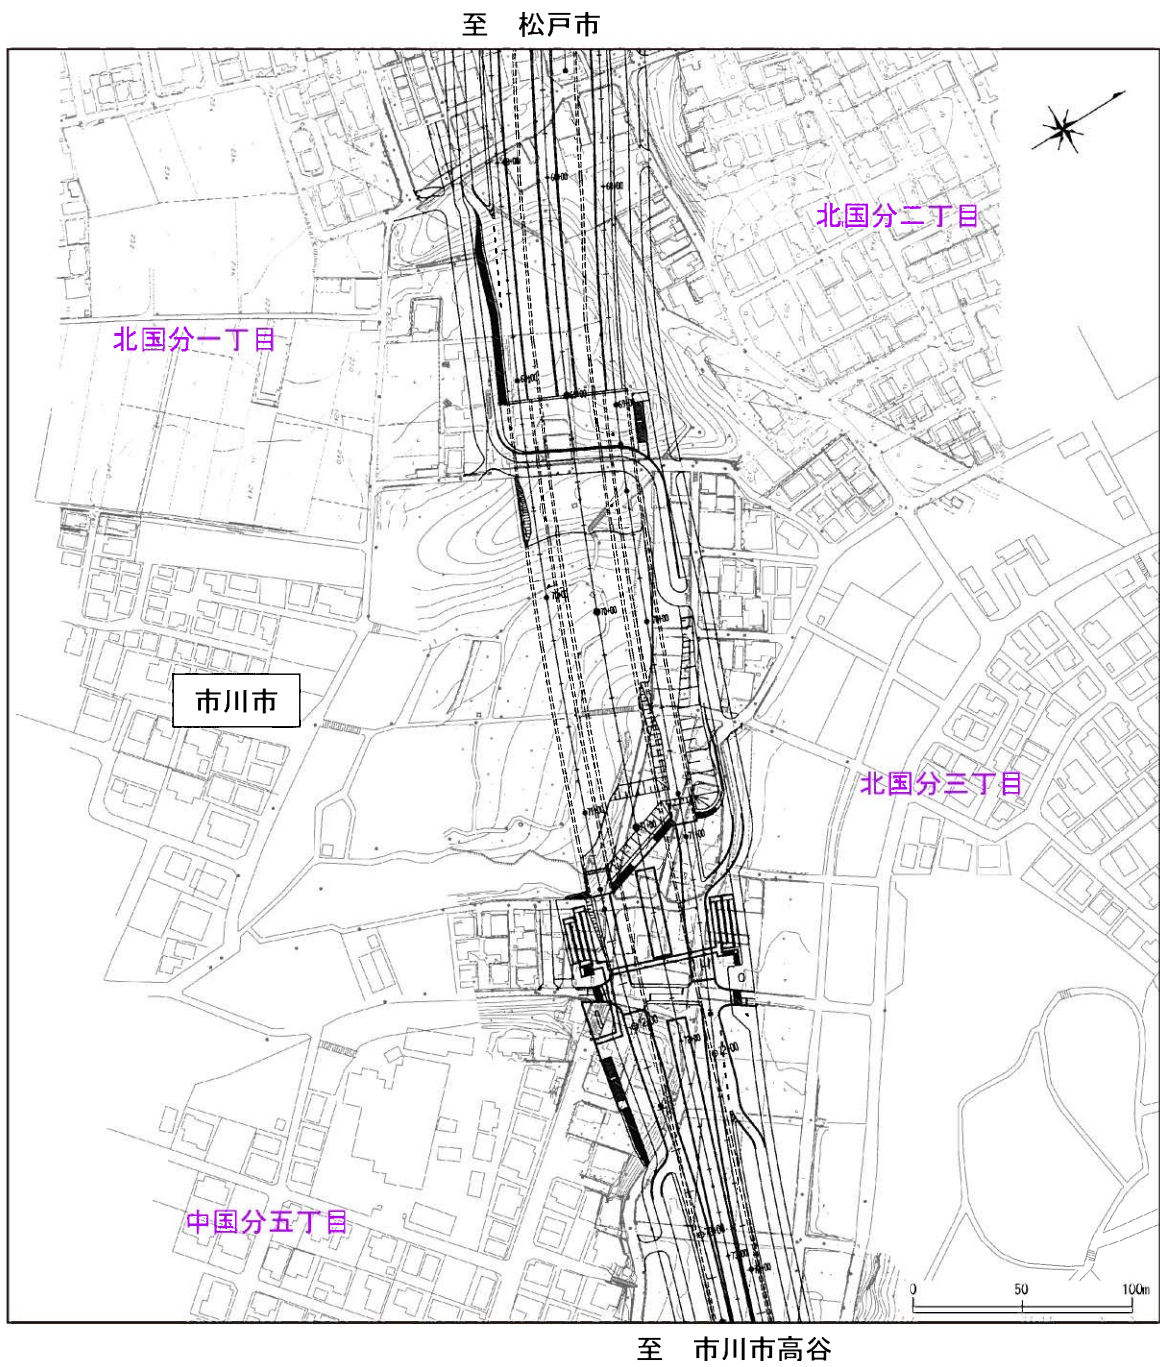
(3) 予測平面図 (③小塚山蓋掛区間)
